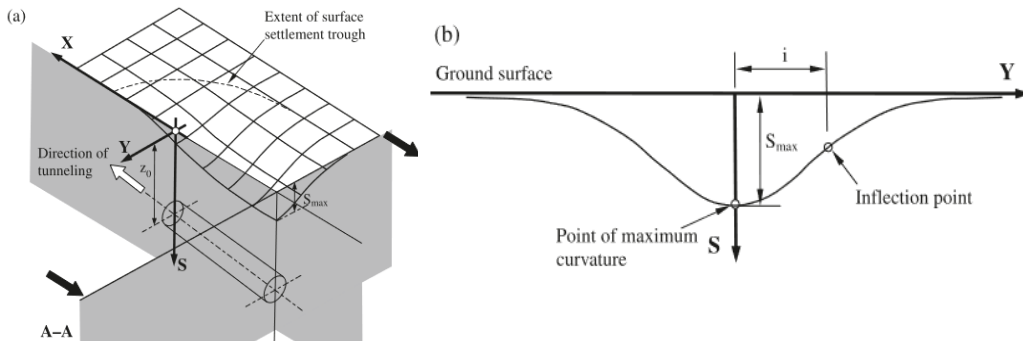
Affaissement du sol induit par le creusement d'un tunnel : (a) vue tridimensionnelle ; (b) section transversale A-A (modifiée d'après Attewell et al. 1986)
